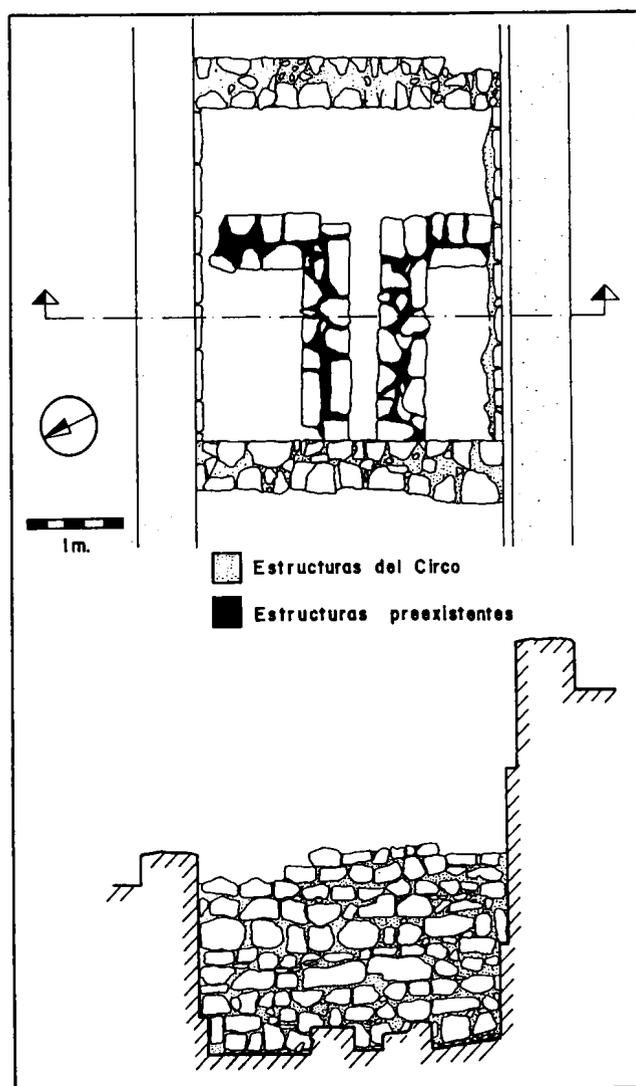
Planta y sección del sondeo "Circo 1993" (celda de cimentación y estructuras preexistentes).
